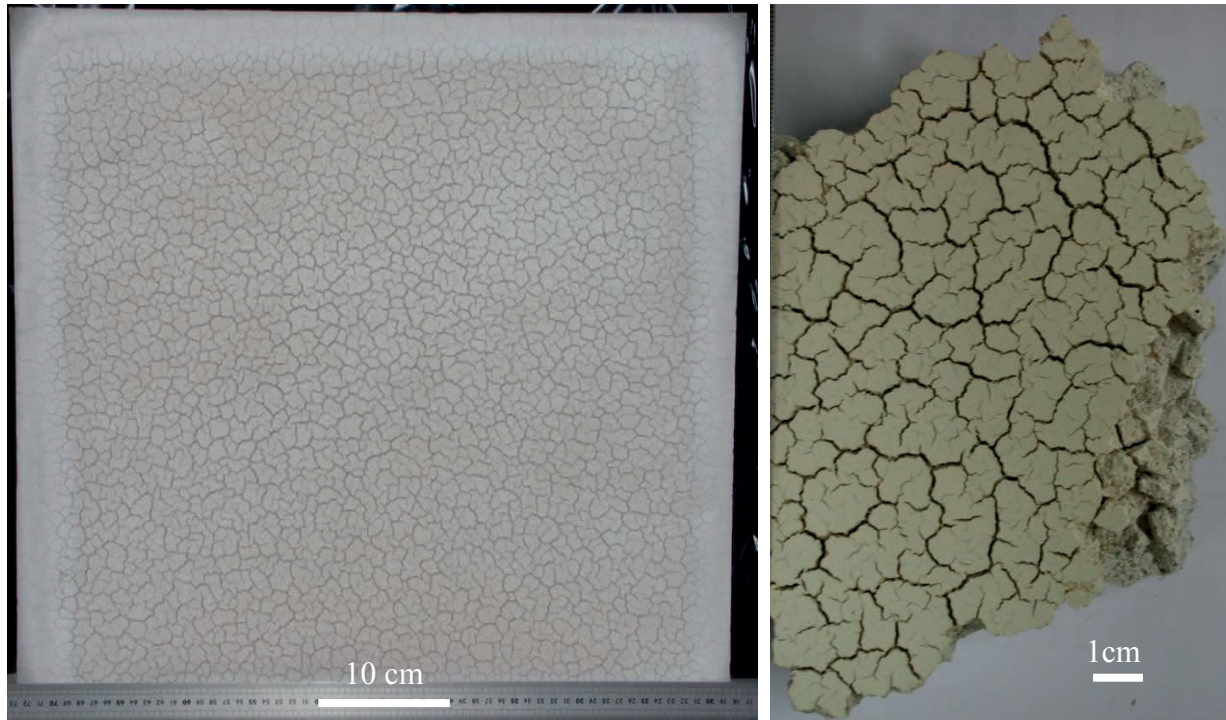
Photographies de la face chaude après 4h d'essai.
